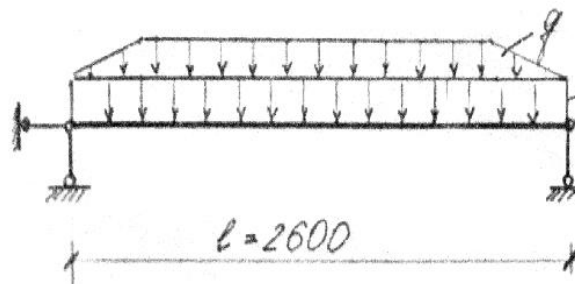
Спрощена розрахункова схема ребра сходового майданчика
